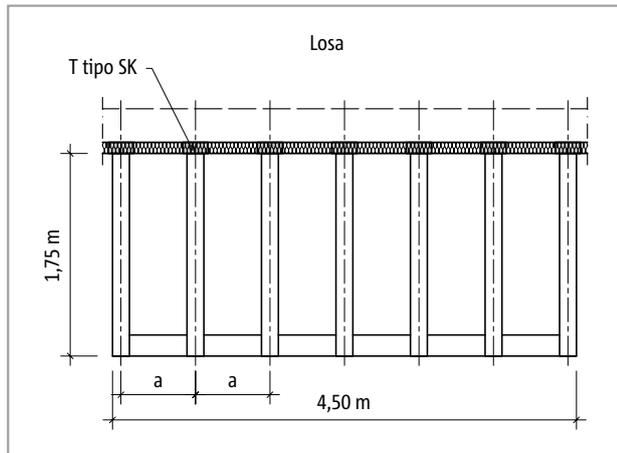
Schöck Isokorb® T tipo SK: Plano
